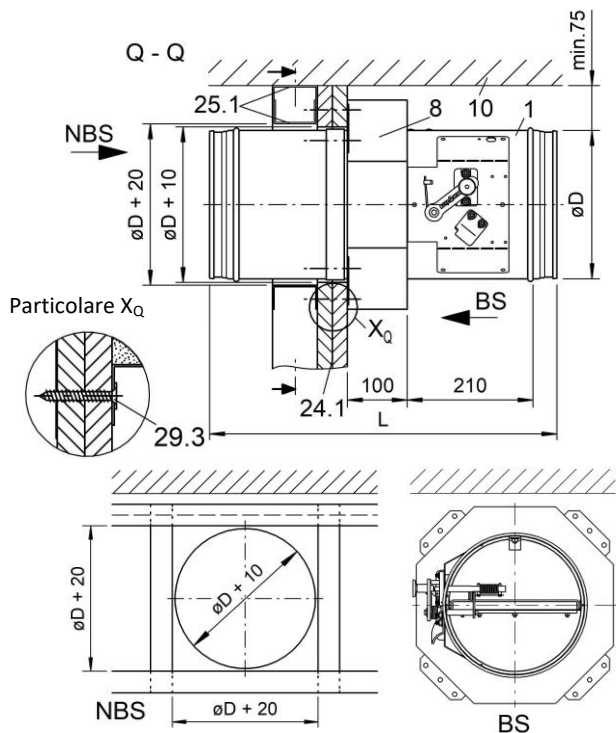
montaggio a secco con telaio AR su parete pozzetto sotto soffitto massiccio
